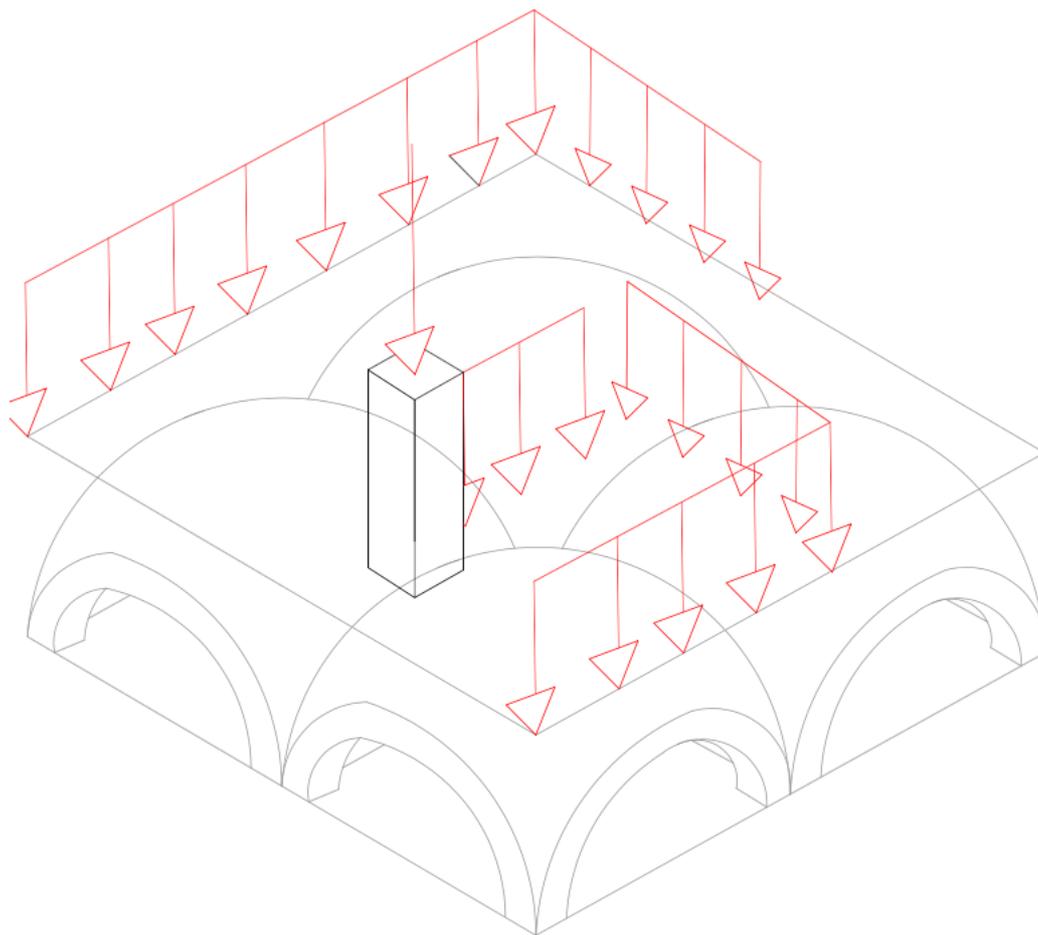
Primera planta superpuesta con mezquita.2017. Plá Gutiérrez, Iván.
